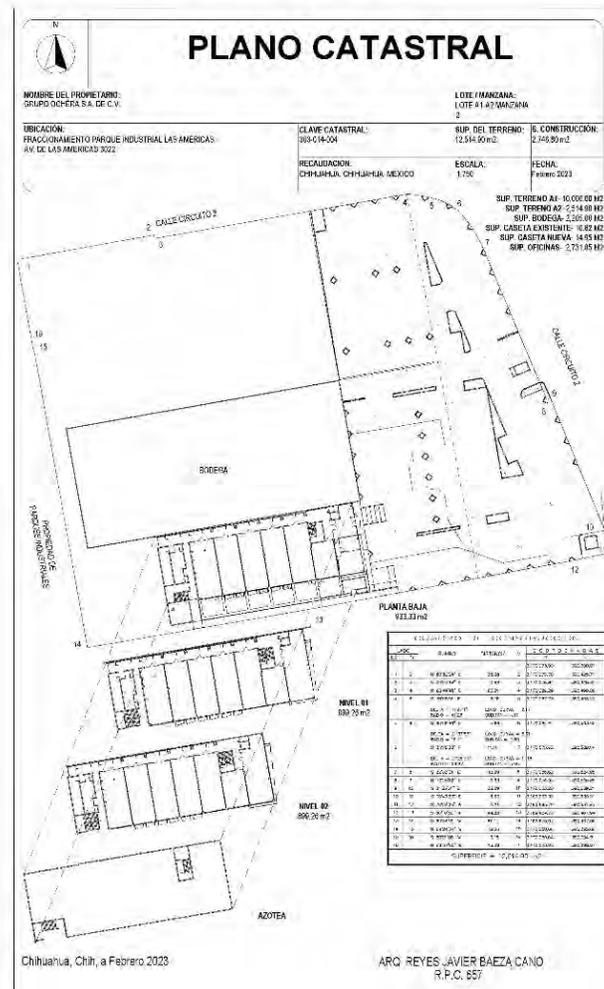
Superficie Construida. Fuente. Plano Catastral.
